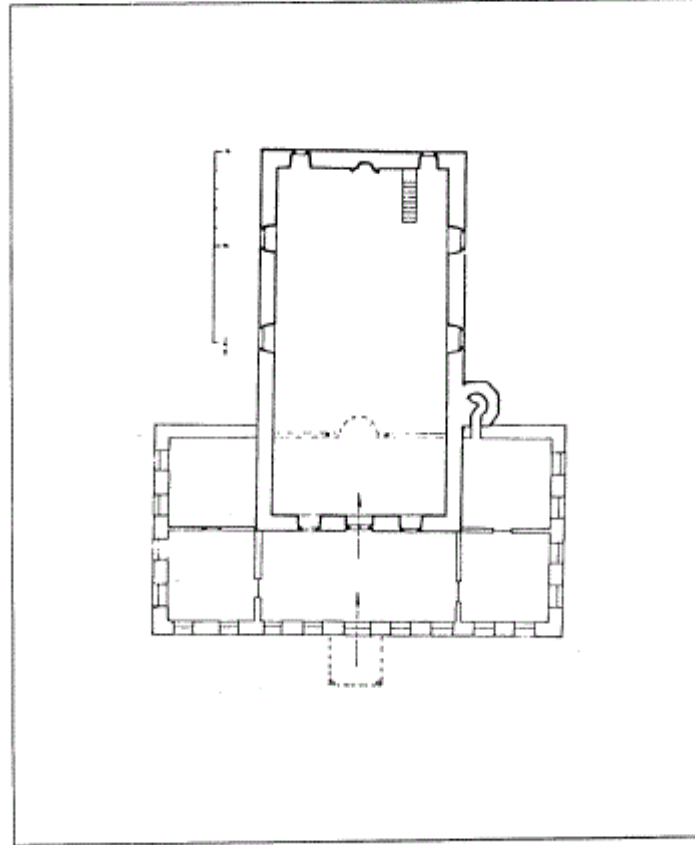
مسقط أفقي لمسجد حسام الدين في اشتب (عن : كيل) .
